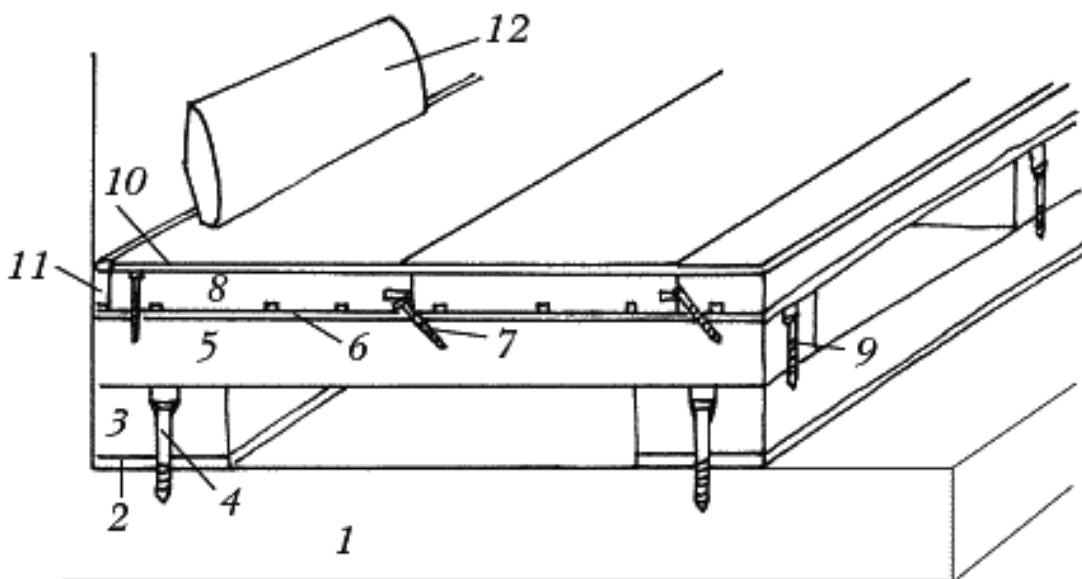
Укладка пола из твердой древесины: 1 – бетонное перекрытие; 2 – резиновый компенсатор; 3, 5 – лаги; 4 – дюбель (гвоздь); 6 – битуминизированный картон; 7, 9 – саморезы; 8 – массивная доска; 10 – грунт + лак (5 слоев) или масло + воск (3-4 слоя); 11 – гидрозамок (герметик); 12 – плинтус
